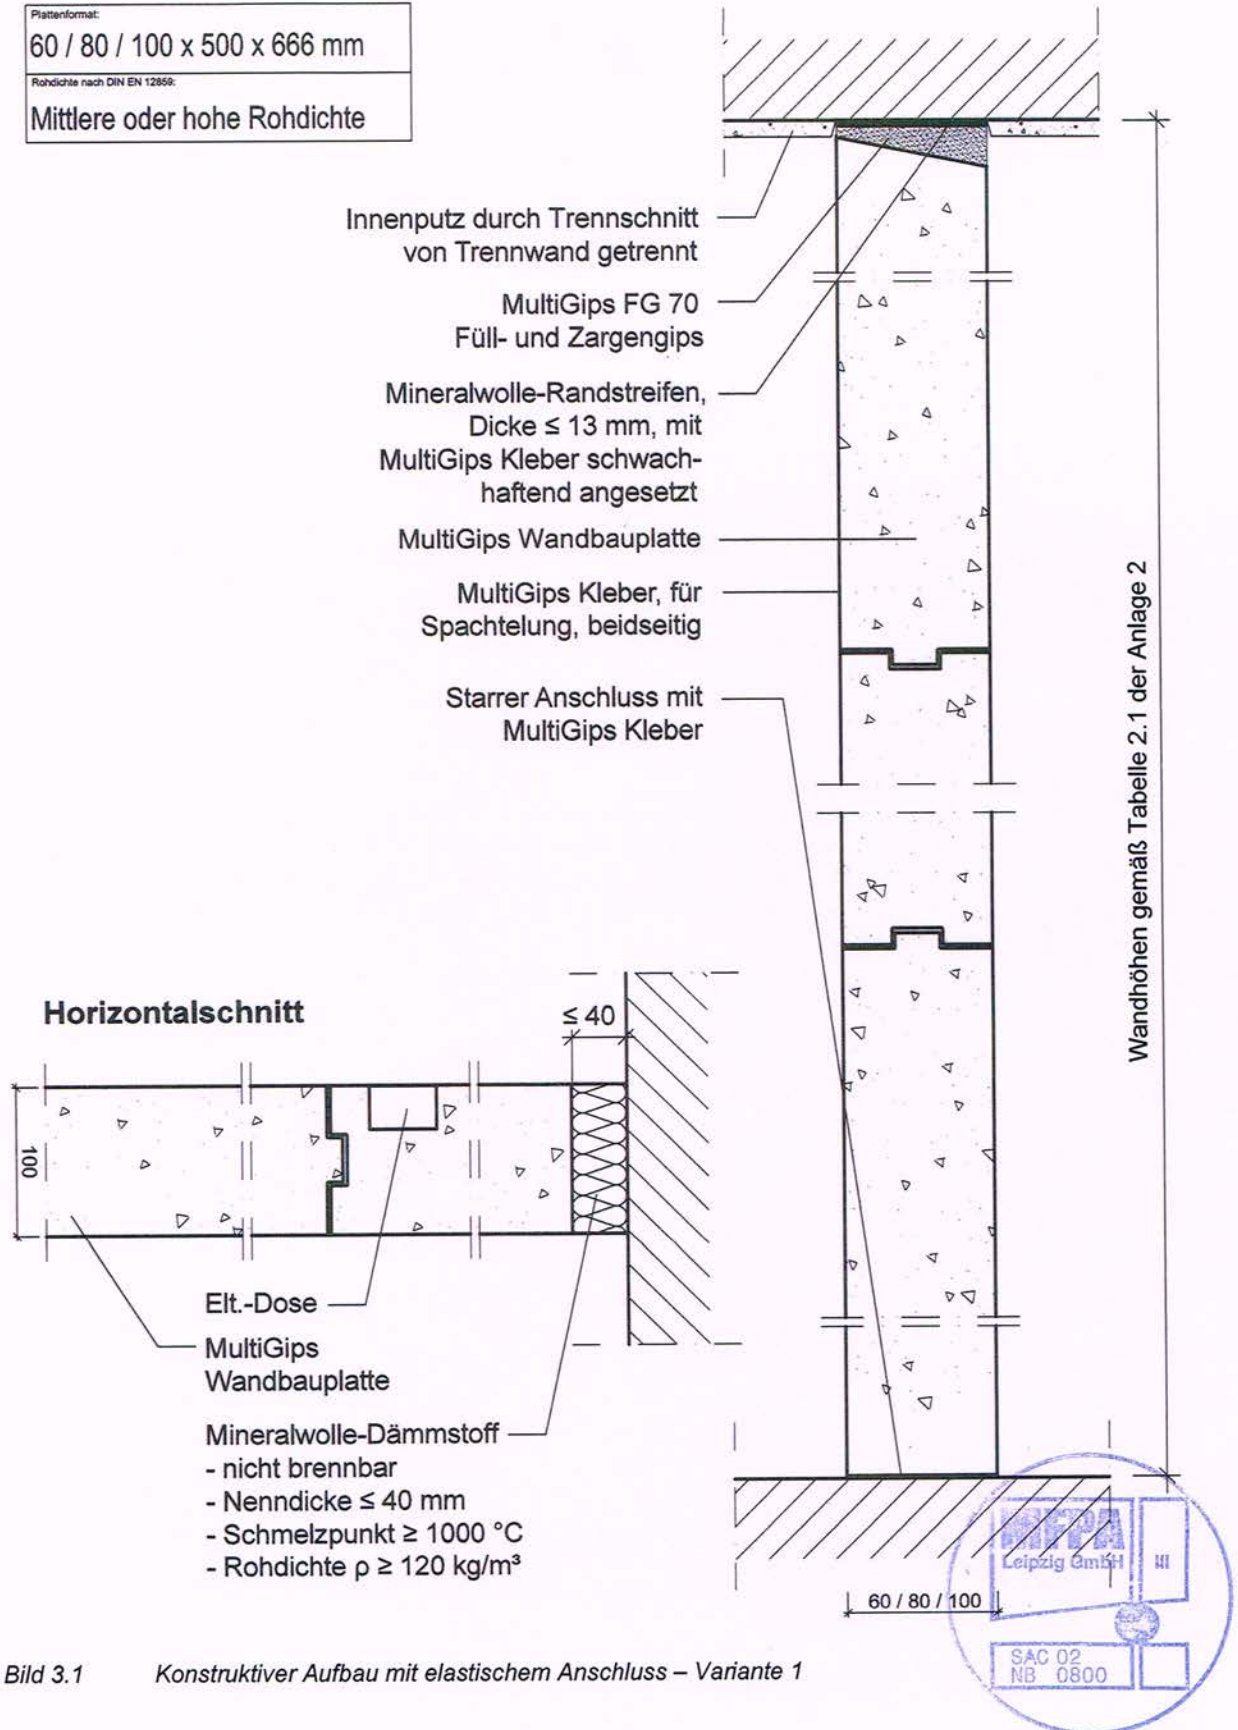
Konstruktiver Aufbau mit elastischem Anschluss – Variante 1
